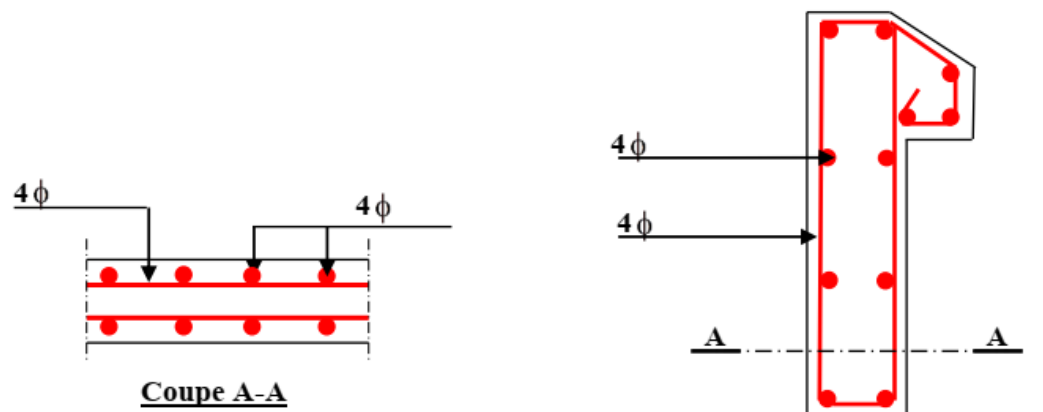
Schéma de ferrailage de l'acrotère (Terrasse inaccessible).
